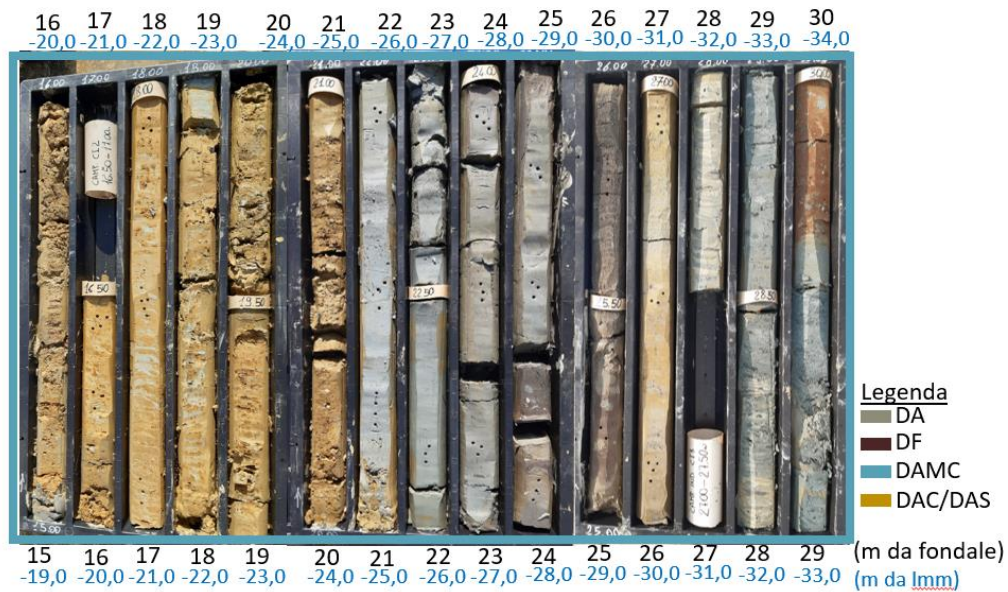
Sondaggio Sb-28 (15 – 30m da fondale)
